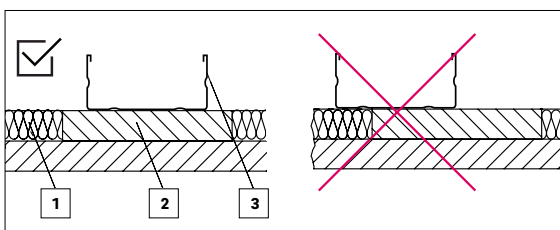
Korrekte Befestigung der Kühldeckenelemente
